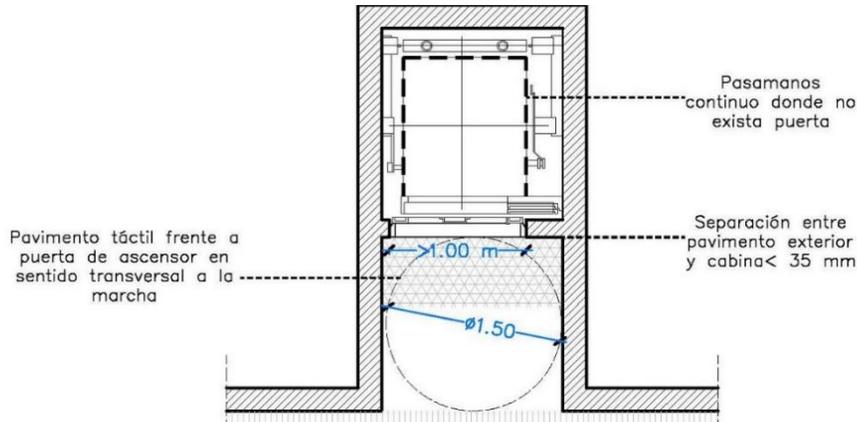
Planta para un ascensor seguro. (3.bp.blogspot.com)
